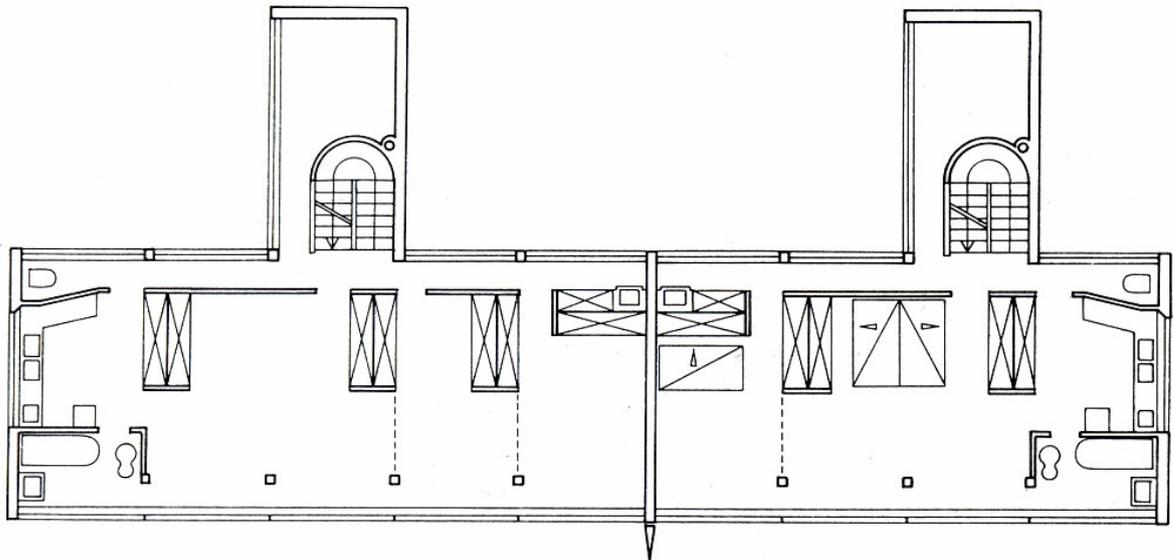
Doppelwohnhaus, Grundriss Wohngeschoß (gezeichnet nach den Baueingabeplänen vom Mai 1927, M 1:50)
